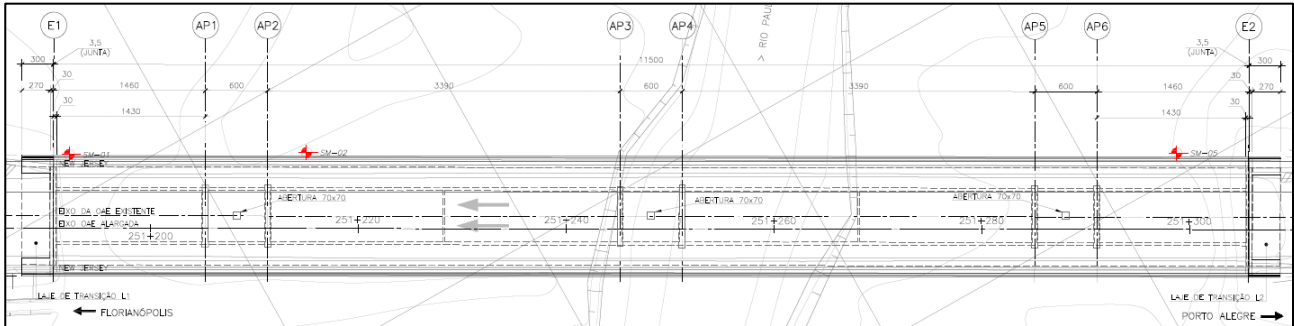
Implantação da ponte sobre o rio Paulo Lopes
